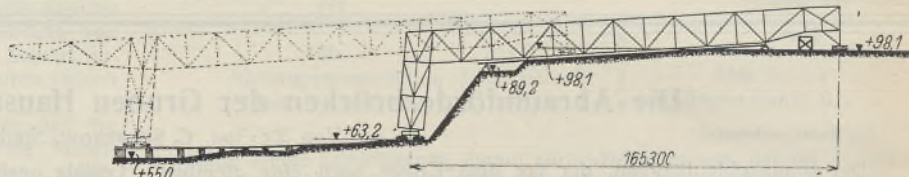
Montagestellung der Brücke „Neurath“. (Punktiert: Stellung nach dem Verschieben.)
